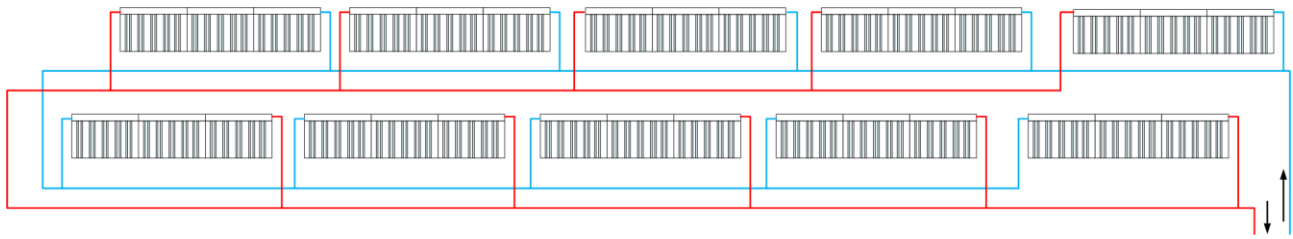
; schema dell'impianto solare sul tetto dell'edificio F51, i pannelli sono uniti a gruppi di tre
